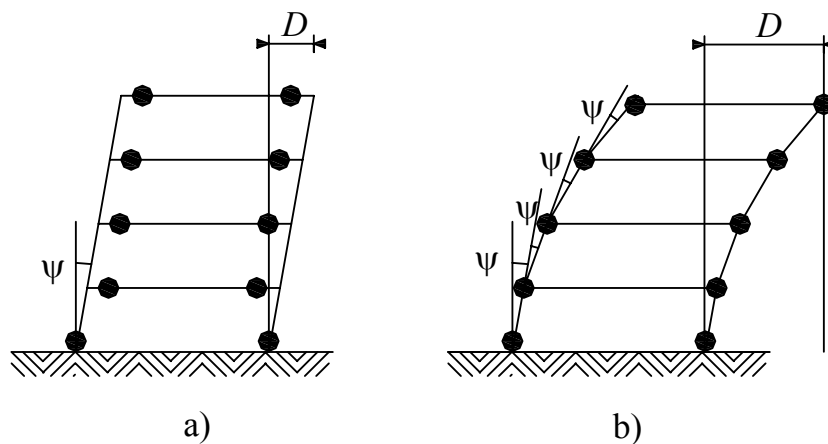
a) L'objectif de projet "poutres faibles – poteaux forts" b) Les rotules plastiques dans les poteaux entraînent des effets du second ordre plus importants.
